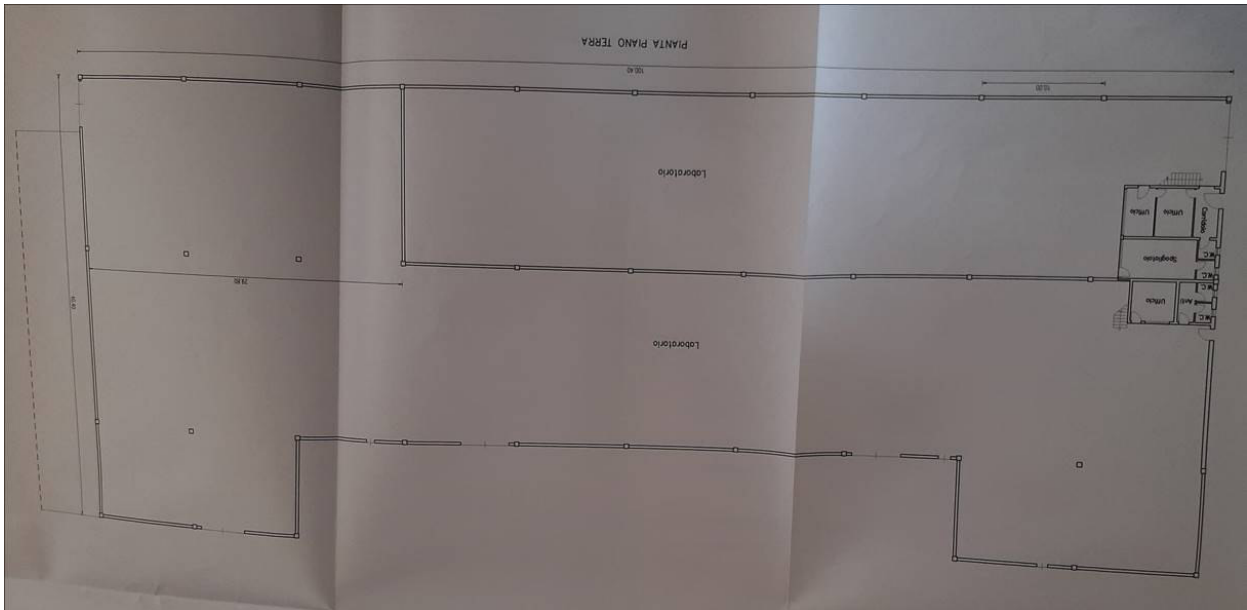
Planimetria progetto DIA 2002 (mancano solo i servizi posti nell'angolo a sud)
